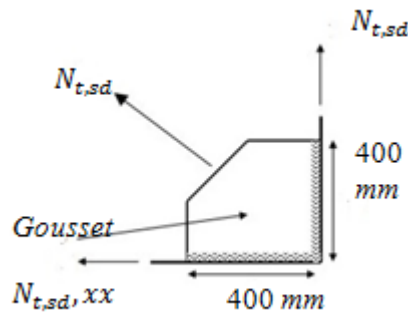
Assemblage gousset - nœud de portique par soudure.
